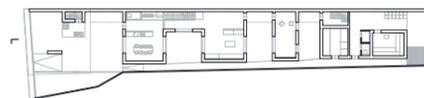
Grundriss Ebene 3 Idlhöfe101
